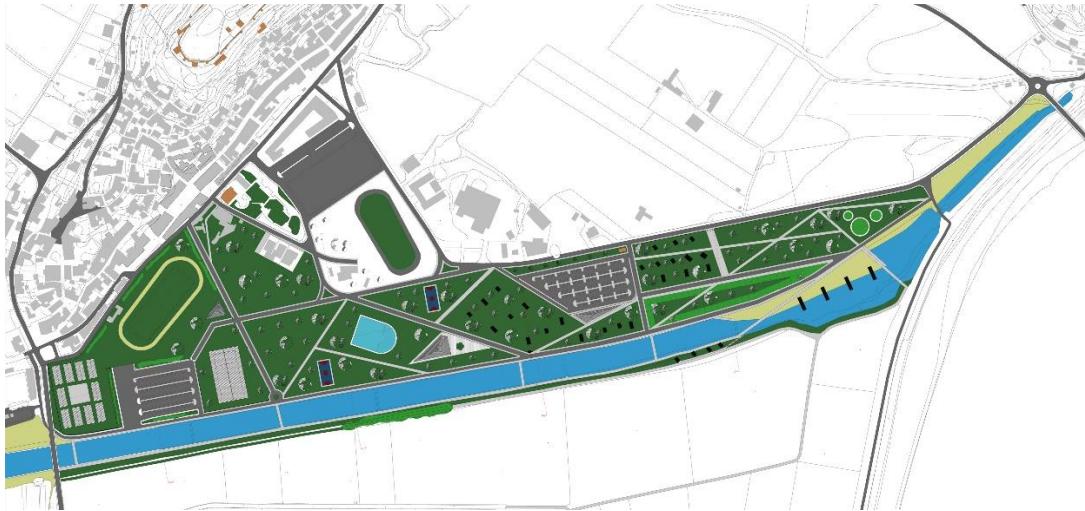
Planta Intervenção - "EcoMondego Park", Anexo 1
